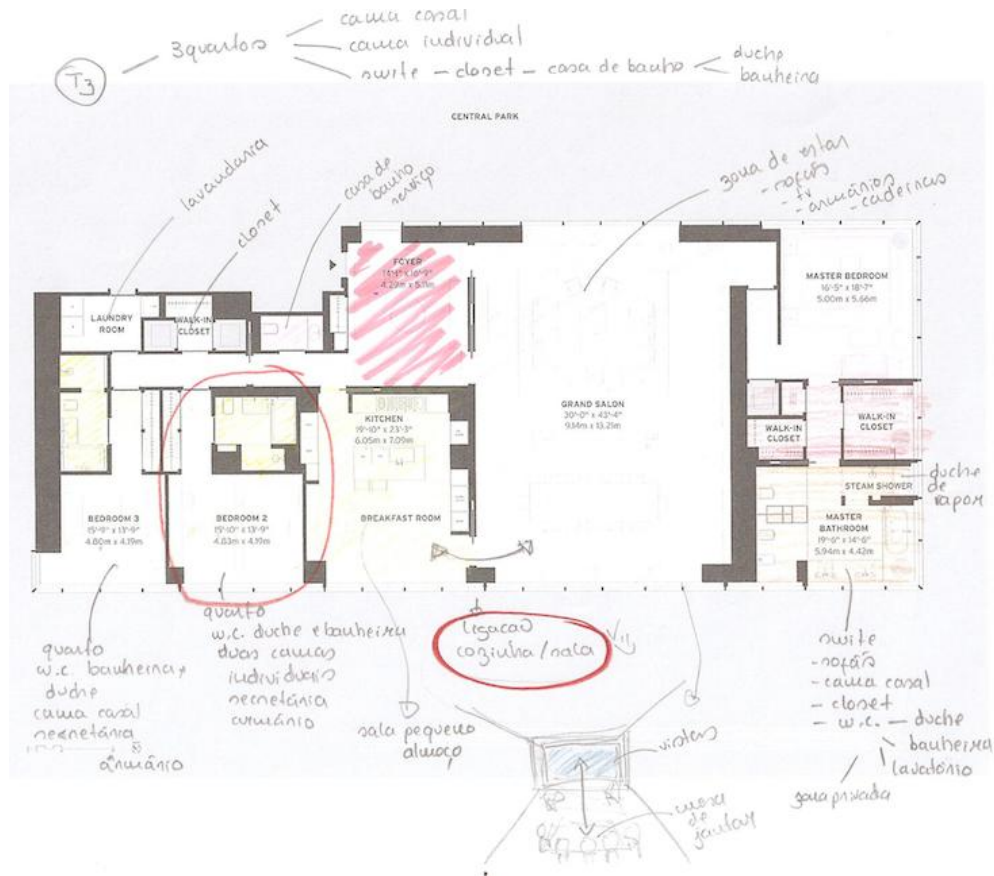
One 57, planta tipo: organização do interior (anotações de elaboração própria).
